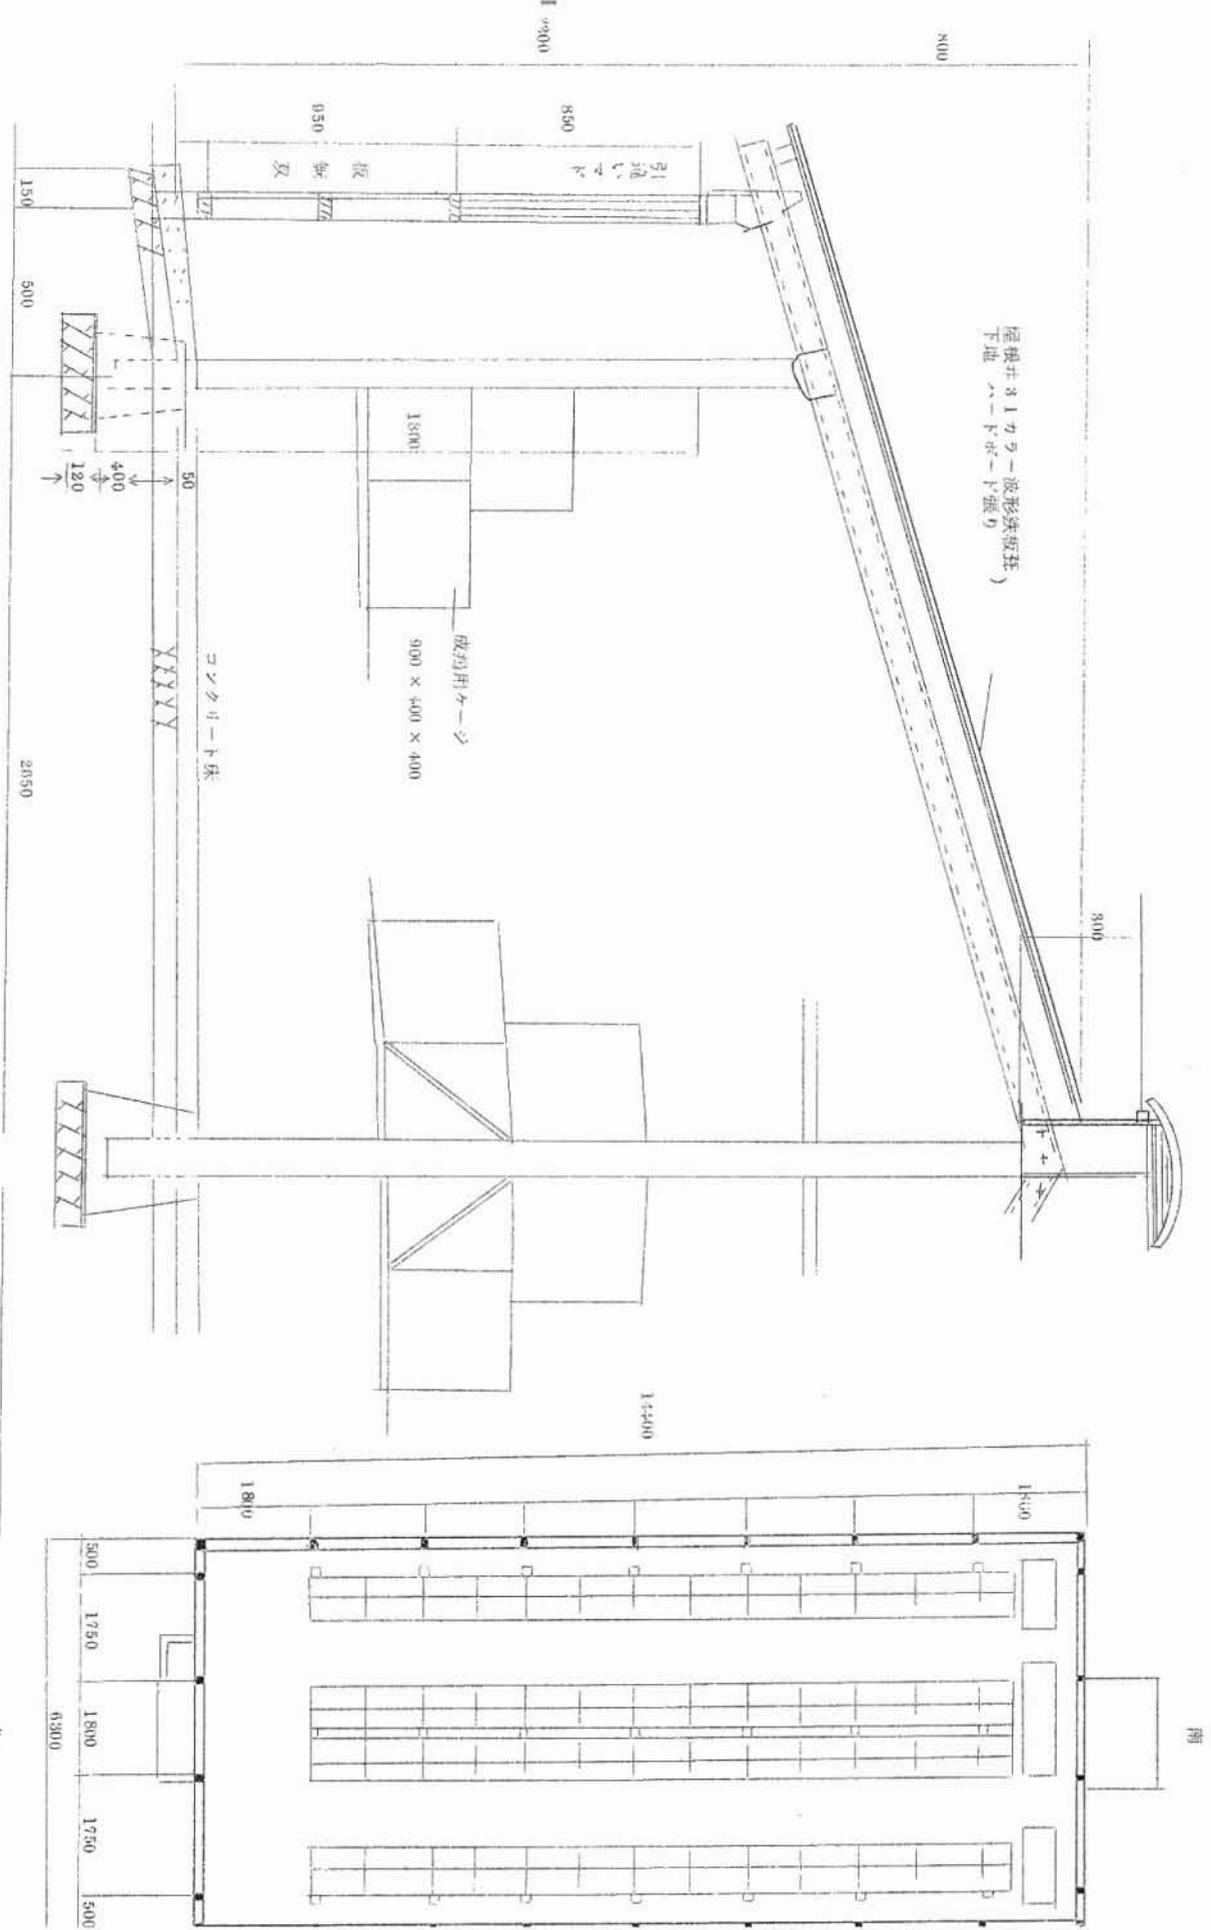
Bケーシング合算計図及び平面図 (縮尺: 1/200)
